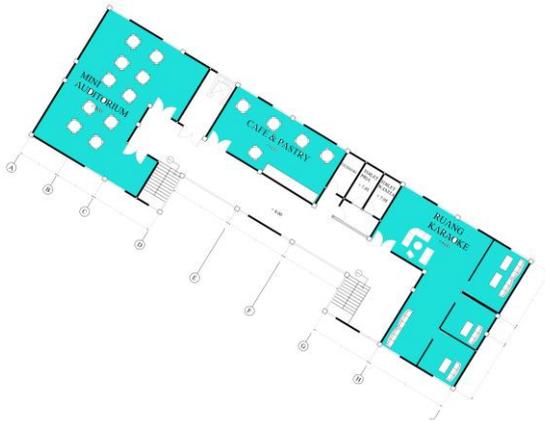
Denah Fasilitas Umum Lantai 1.
